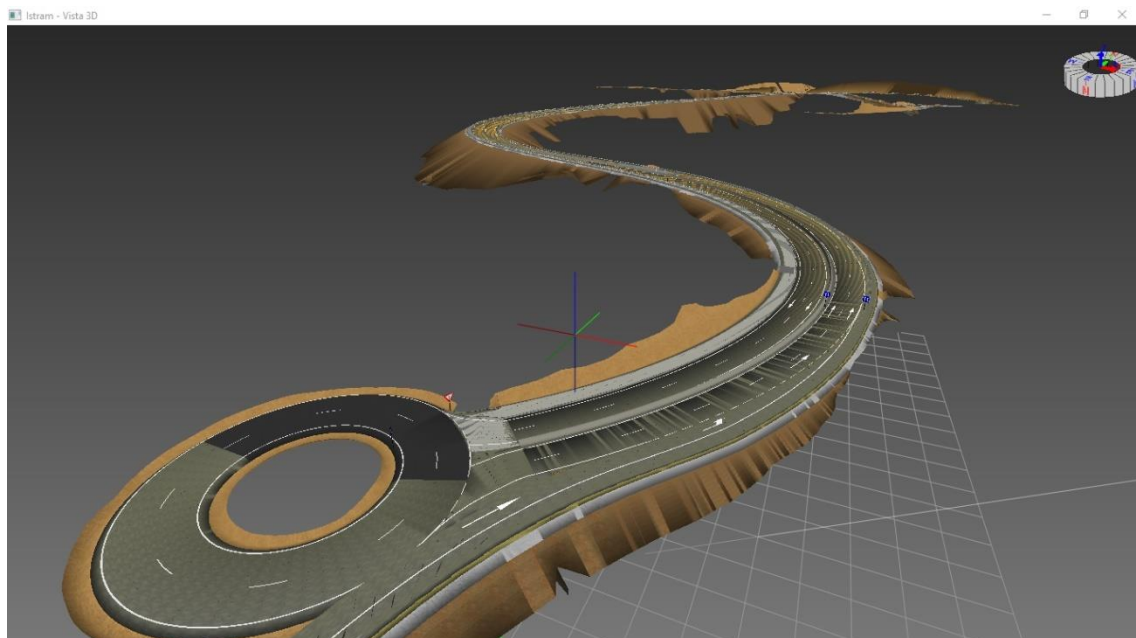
Modelado de la glorieta Ronda Barrios acceso Arrabal
